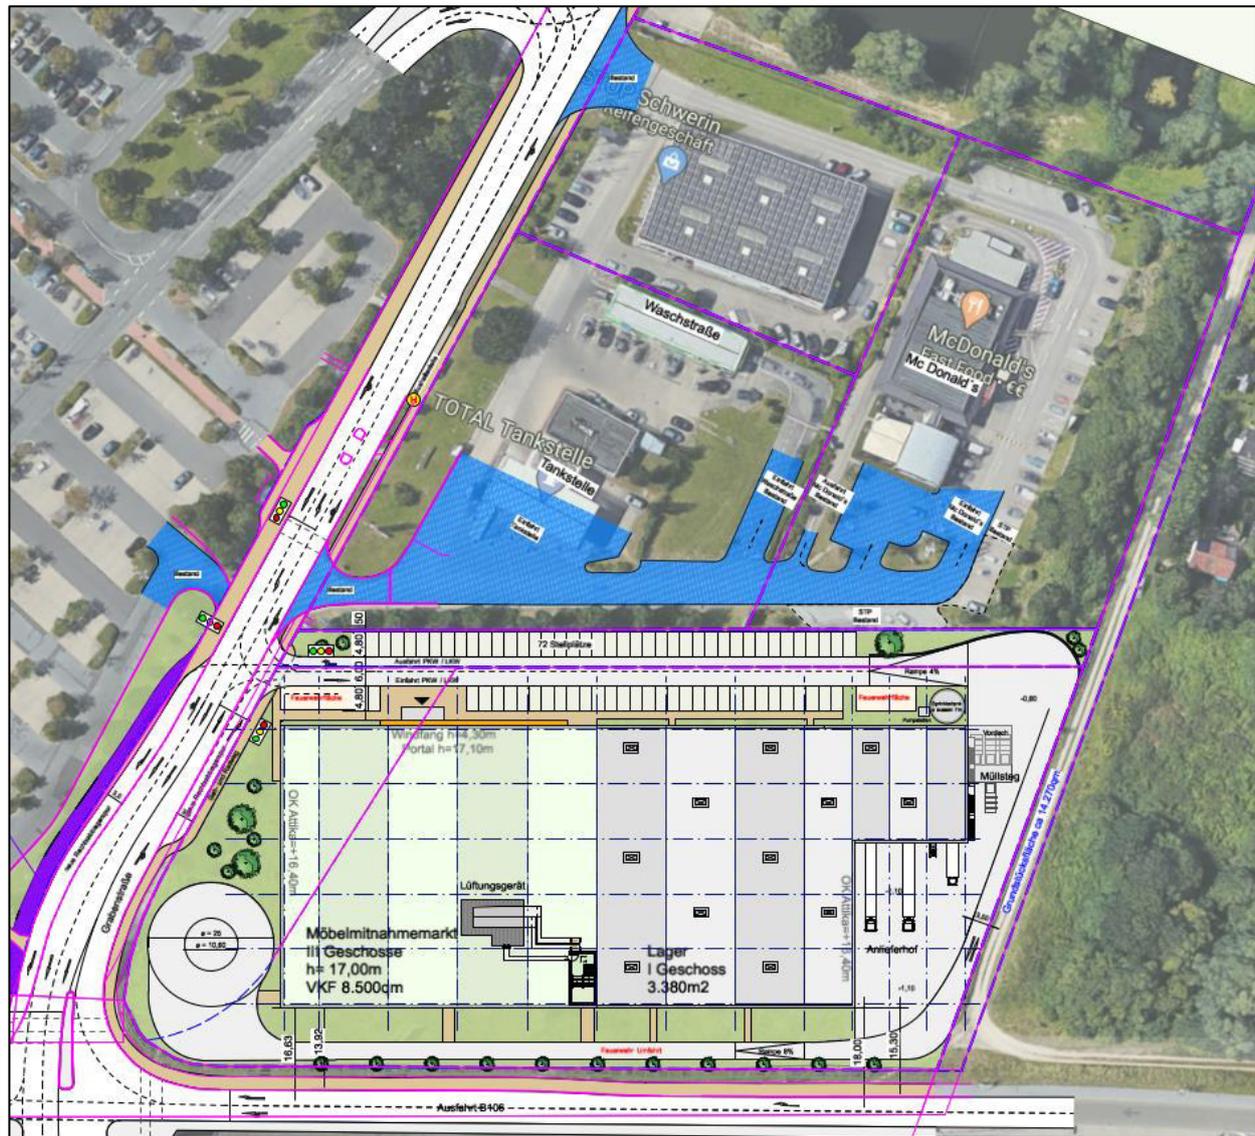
Lageplan BP Nr. 116 mit der Anordnung des SCONTO-Marktes, der Pkw-Stellplätze sowie des Lieferbereiches; Lage der westlichen Gewerbeeinheiten (Lageplan Variante B8 vom 05.03.2021; Quelle: beier baudesign GmbH [4]) (Der Lageplan ist nicht eingenordet)
